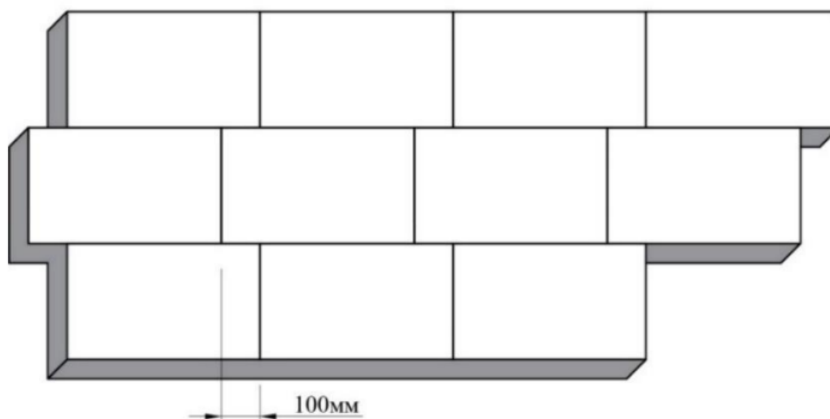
Смещение плит нижнего слоя при укладке
